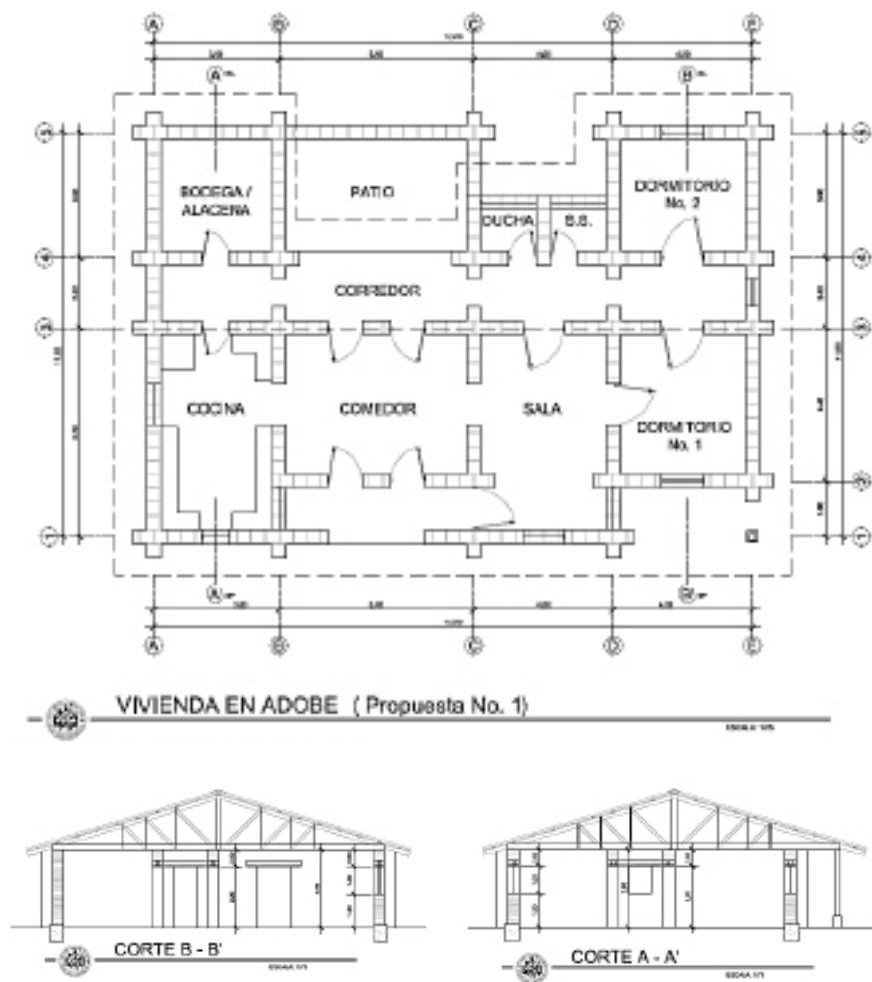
Plano: Una de las propuestas de vivienda en adobe para Santa Rosa
